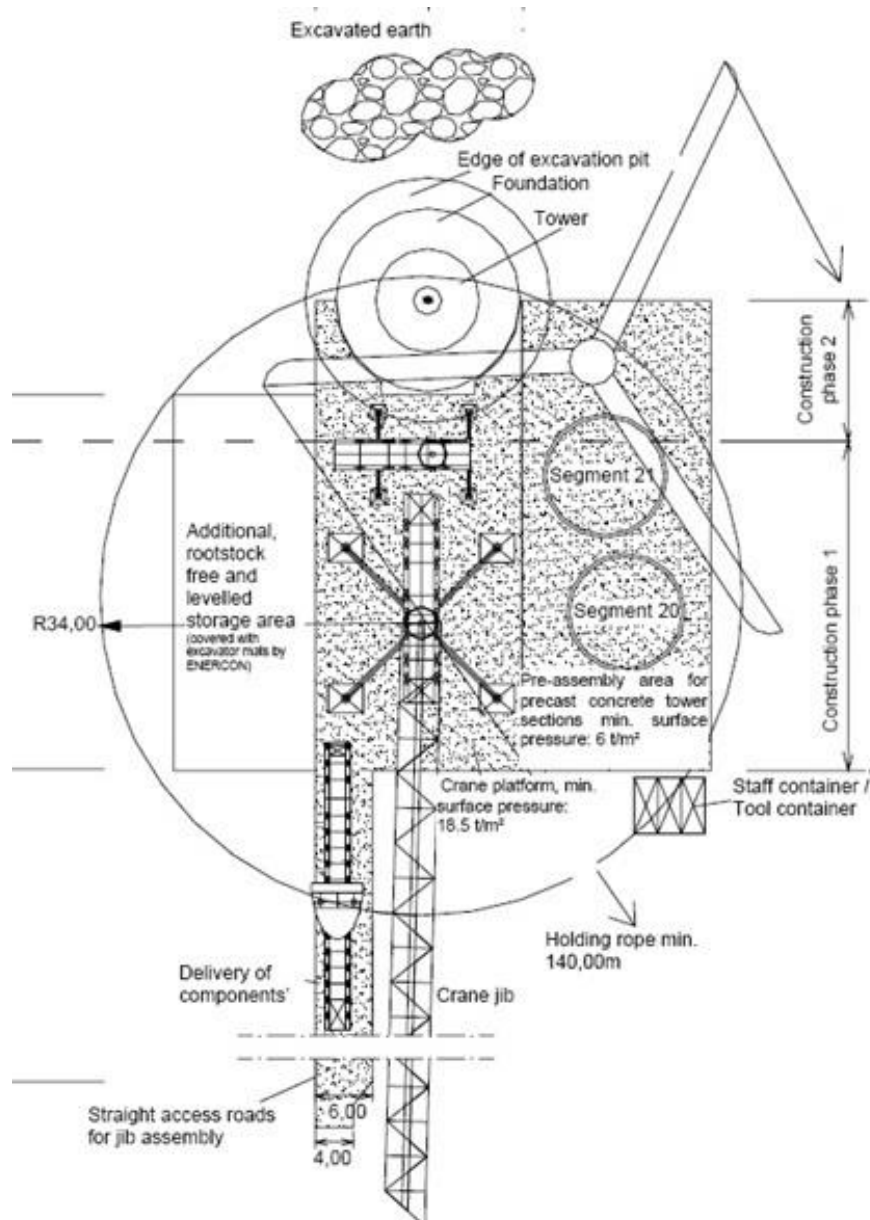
Disposizione delle gru rispetto alle fondamenta e al deposito dei componenti
